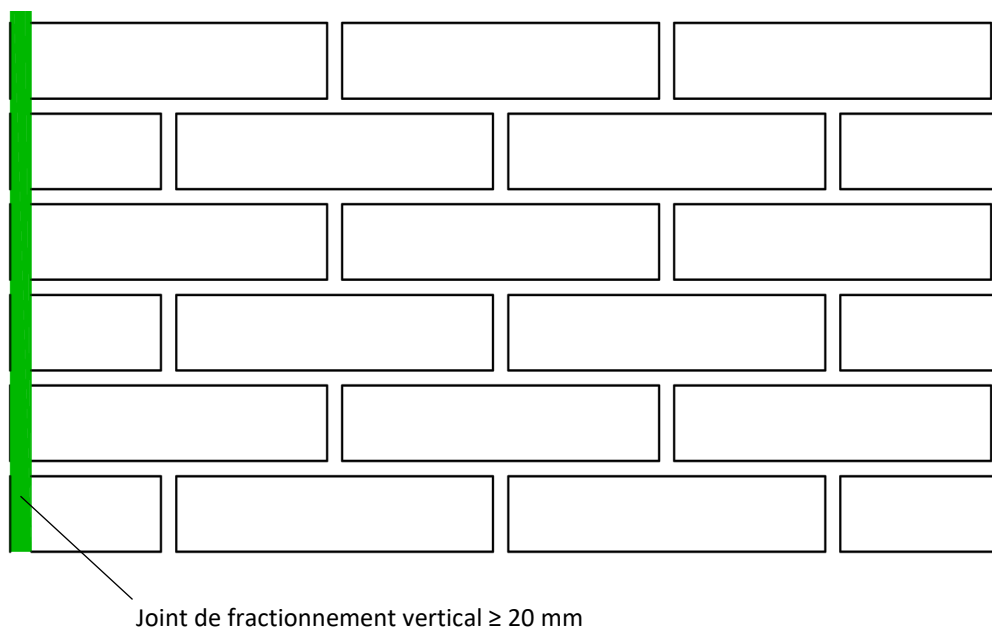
Joint de fractionnement vertical - coupe en bec d'onglet (façade)
